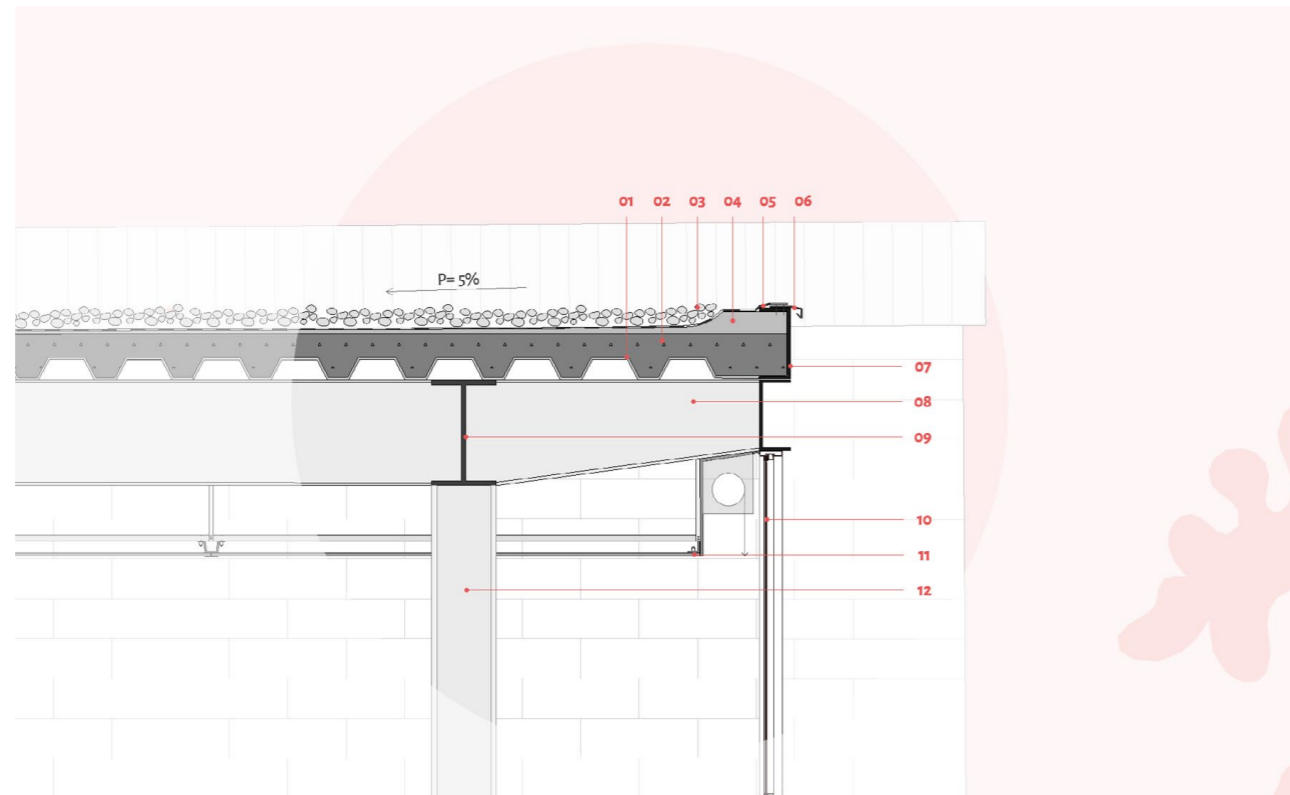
Detalle Constructivo 03 Fuente: Elaboración Propia
